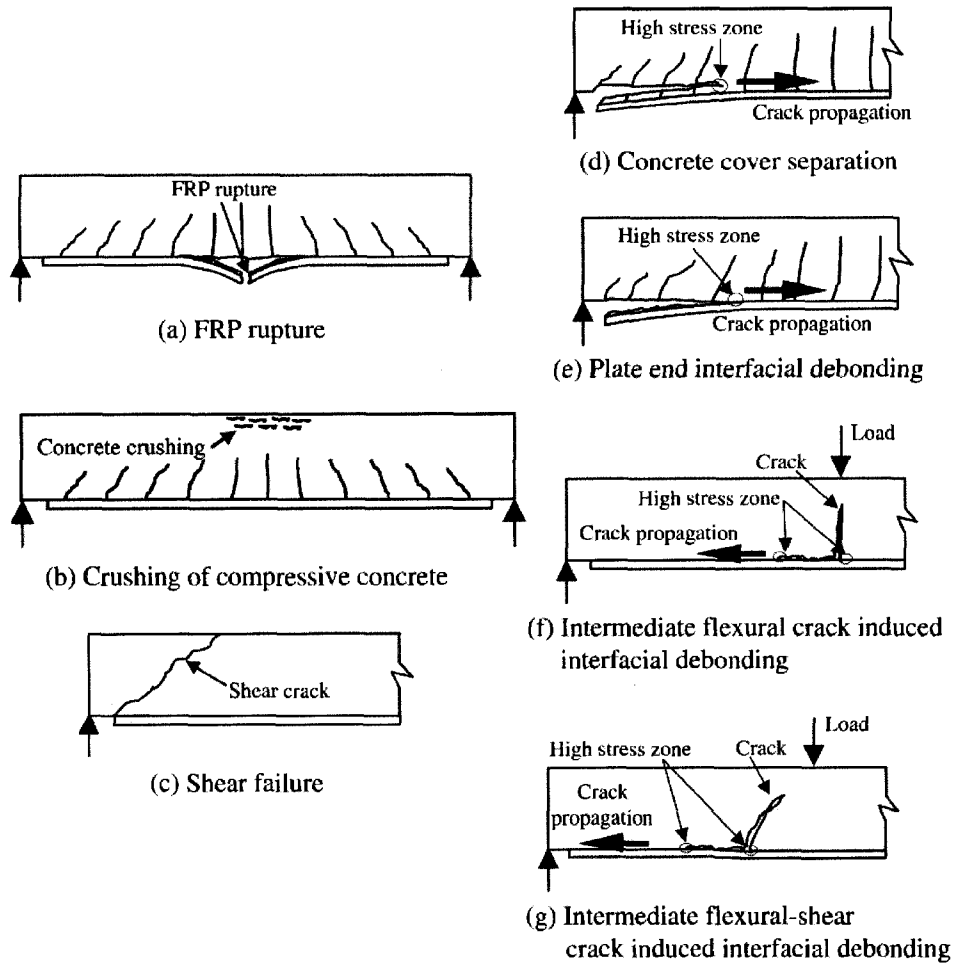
Modes de rupture d'une poutre en béton armé renforcée en flexion par des lamelles de composite (Teng et coll. 2003)
